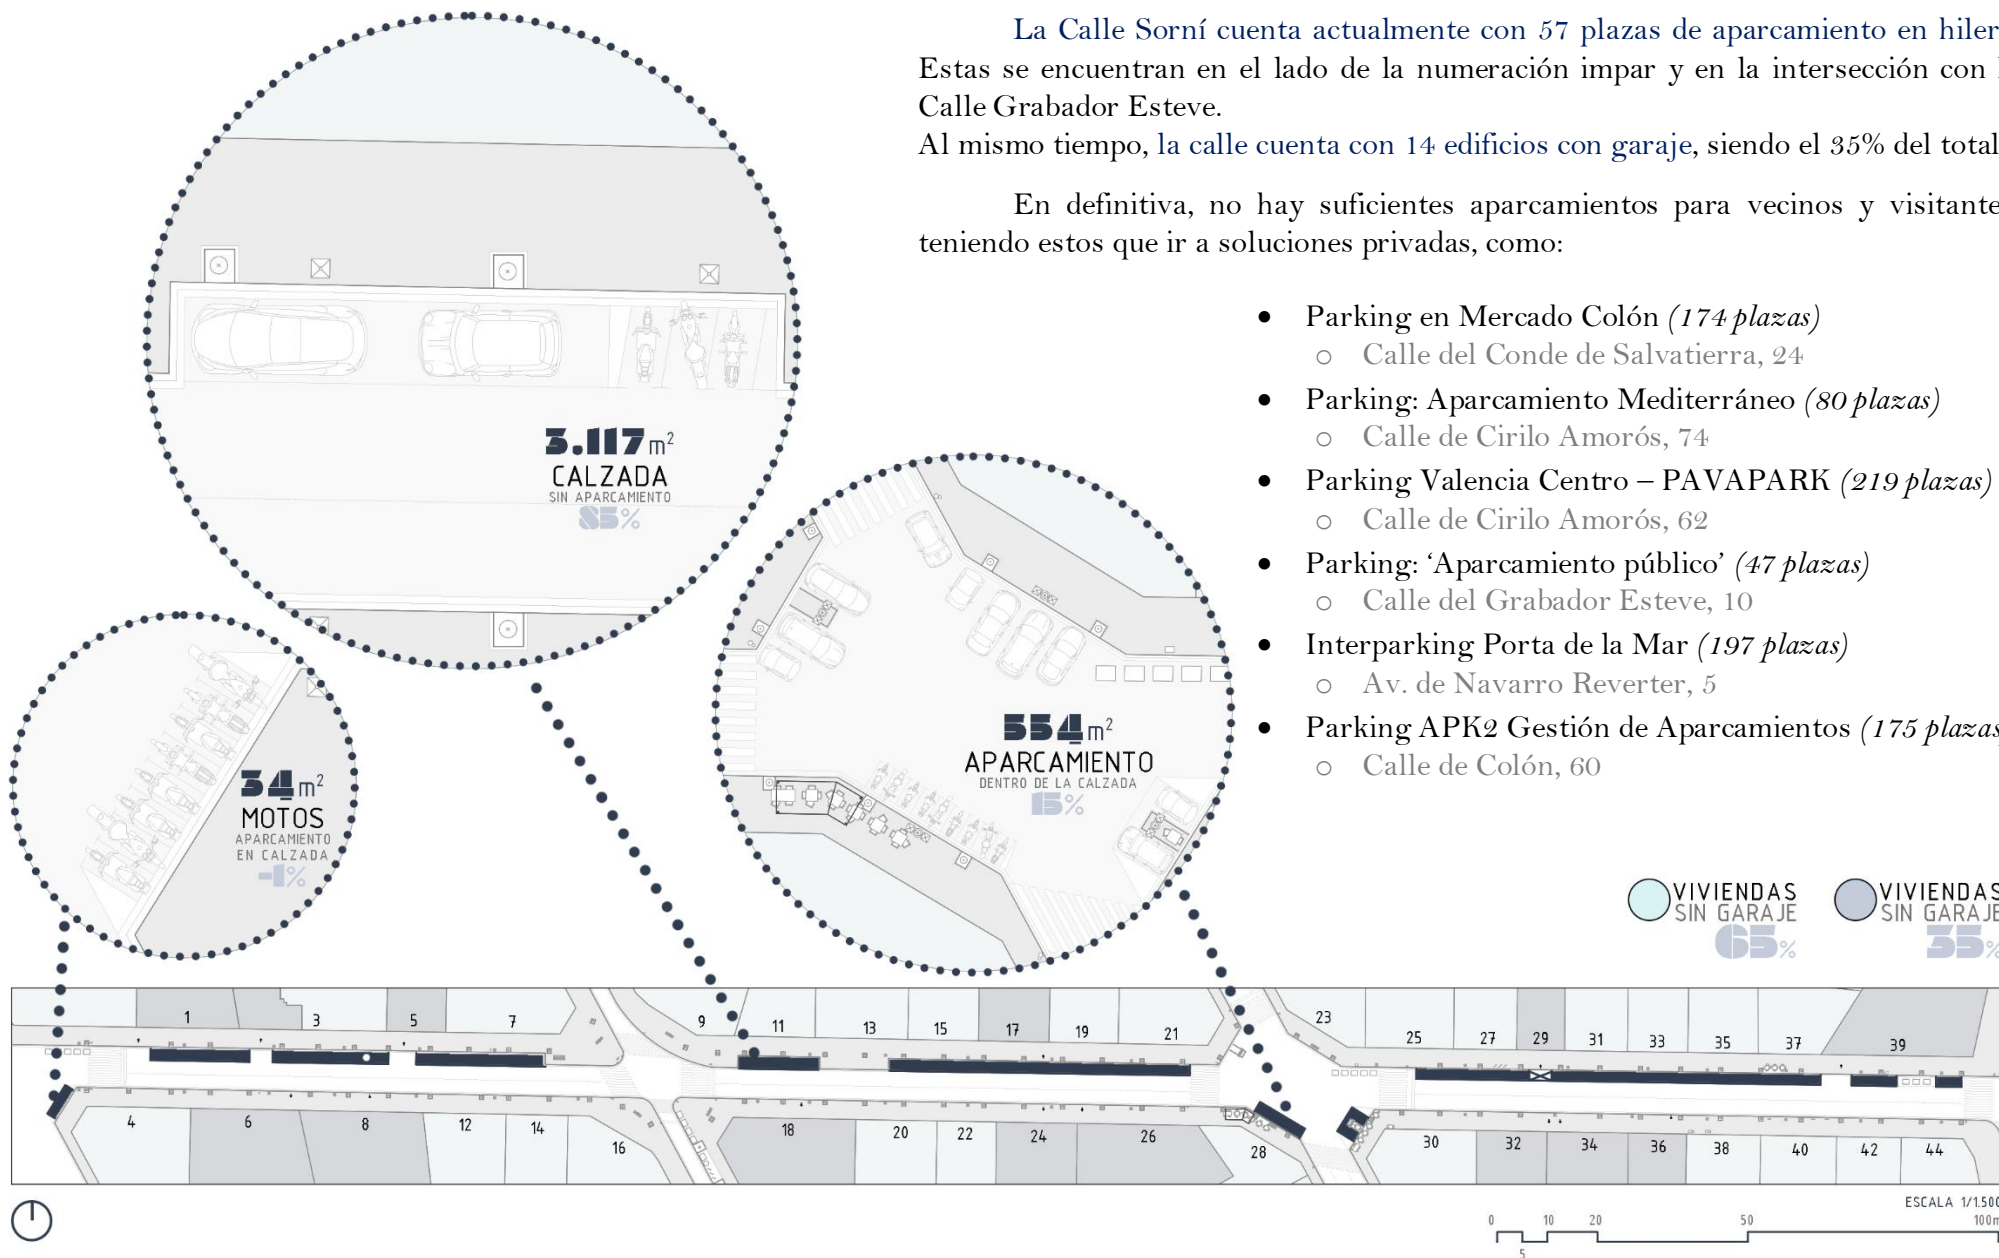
Plano de elaboración propia con detalles del aparcamiento en la Calle Sorní. E 1/1500m
